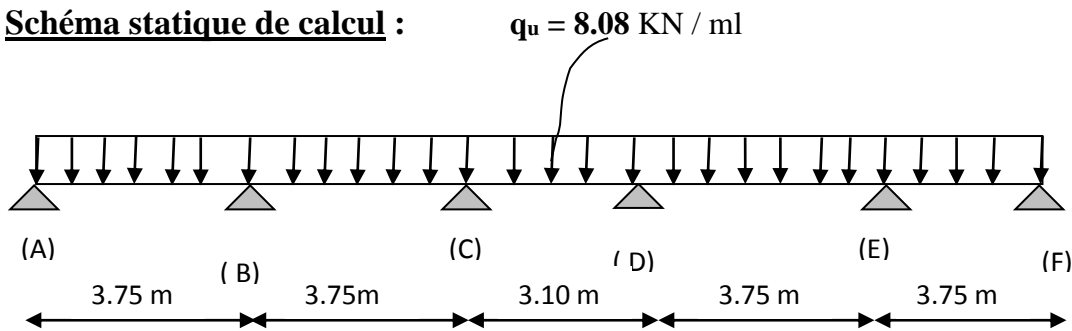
Schéma statique de la poutre continue reposant sur six appuis
